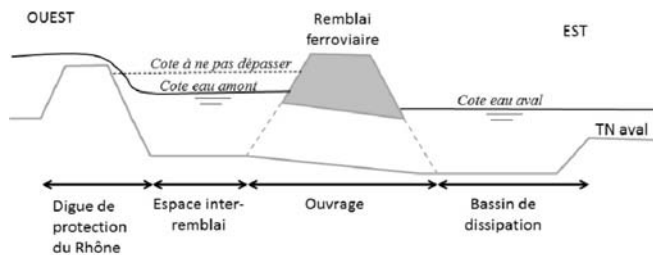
COUPE TRANSVERSALE AU DROIT D'UN OUVRAGE
